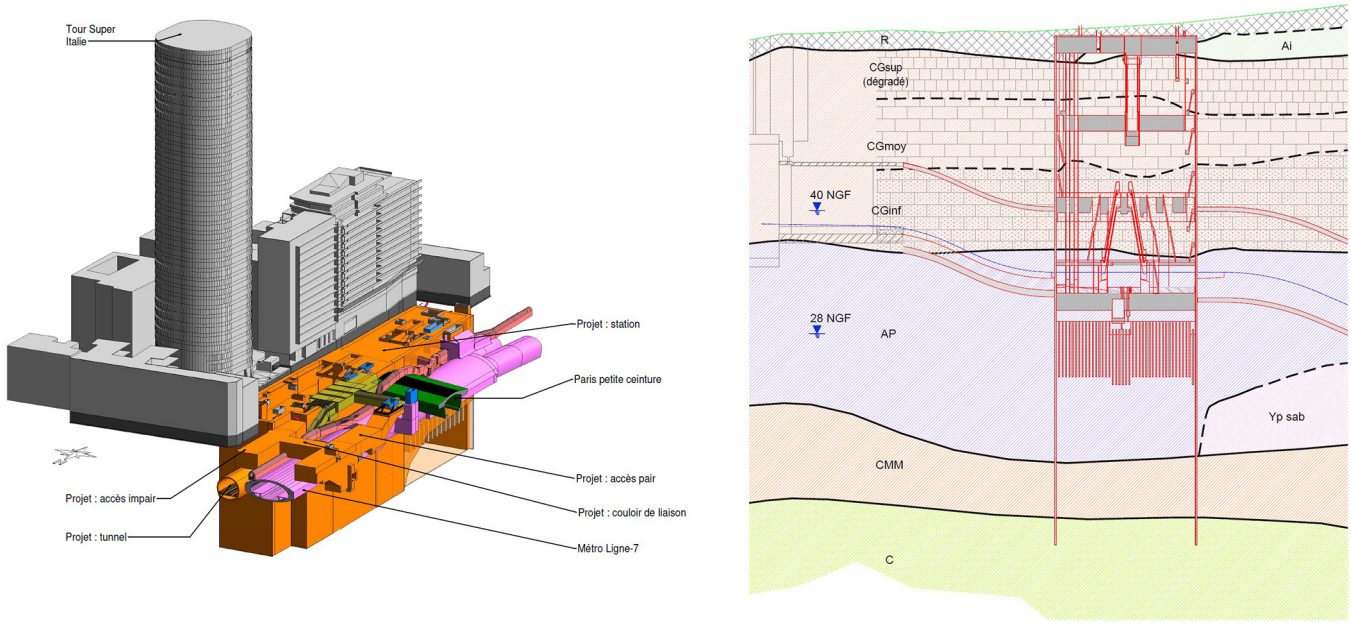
Gare Maison-Blanche avec les constructions voisines et coupe géologique du site.
